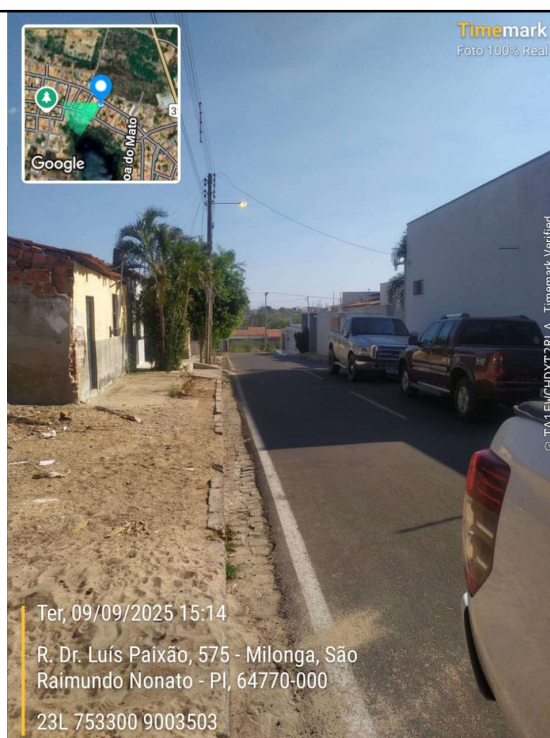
Trecho do traçado do emissário que acompanhará o alinhamento da Rua Dr. Luís Paixão, em área já pavimentada
